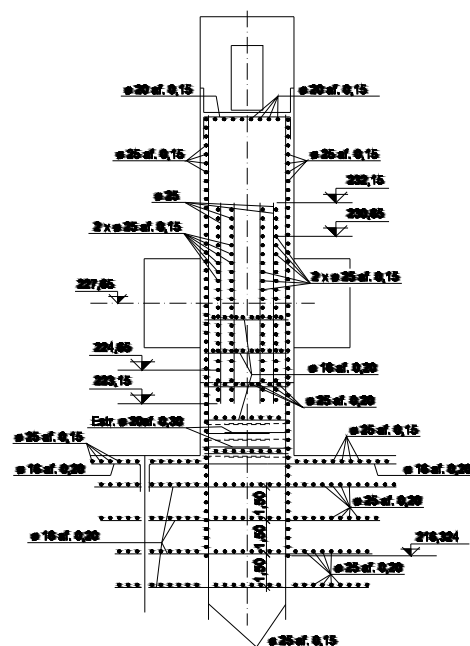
Pilar PE3 - Armaduras –Corte G-G
